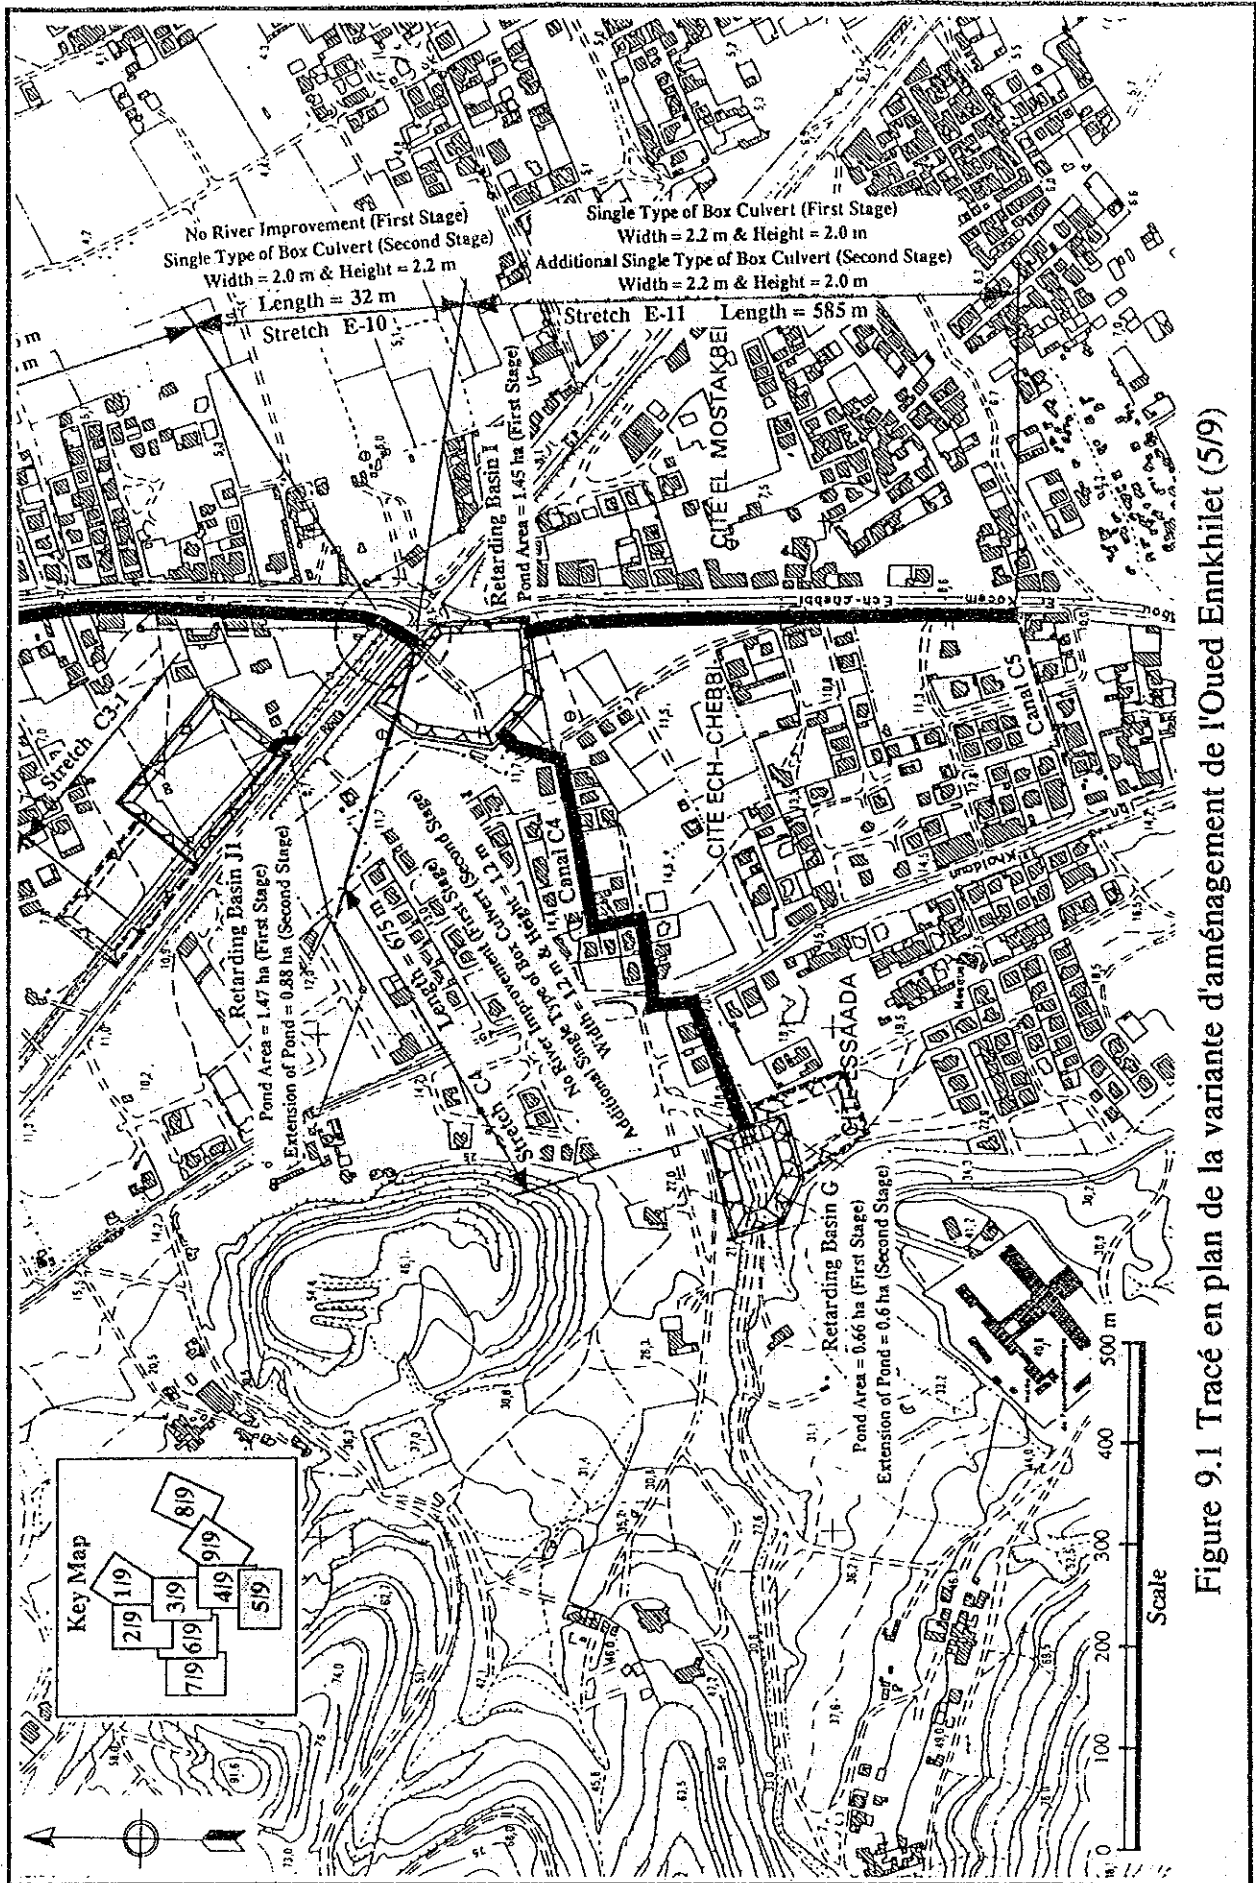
Tracé en plan de la variante d'aménagement de l'Oued Ennkhiilet (5/9)
